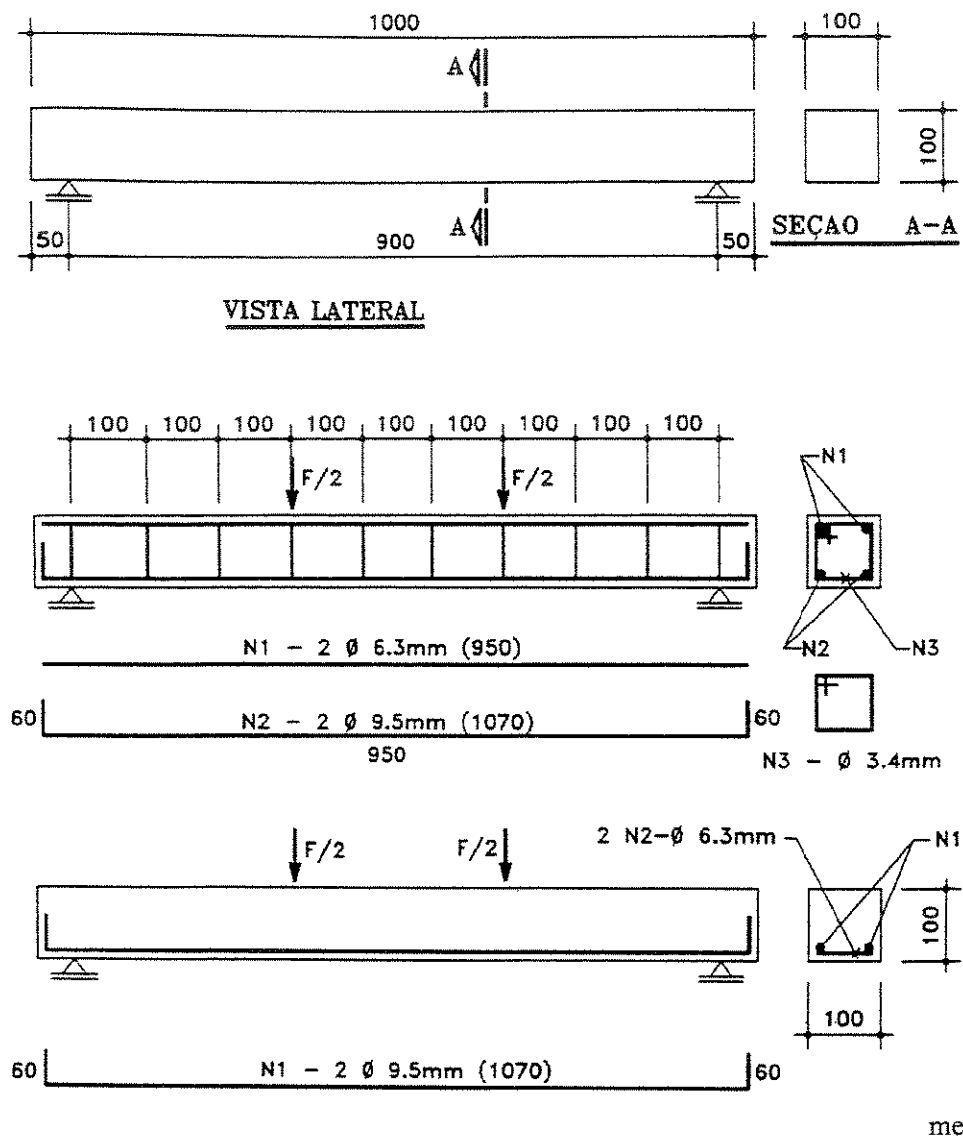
Características geométricas, de armação e de carregamento das vigas ensaiadas por Furlan Jr. e Hanai¹⁹
